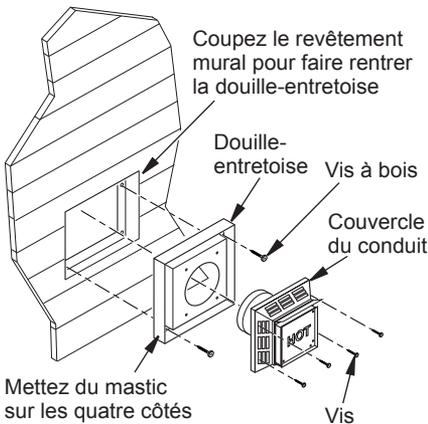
Installation de la douille-entretoise du revêtement mural (mur extérieur combustible)
